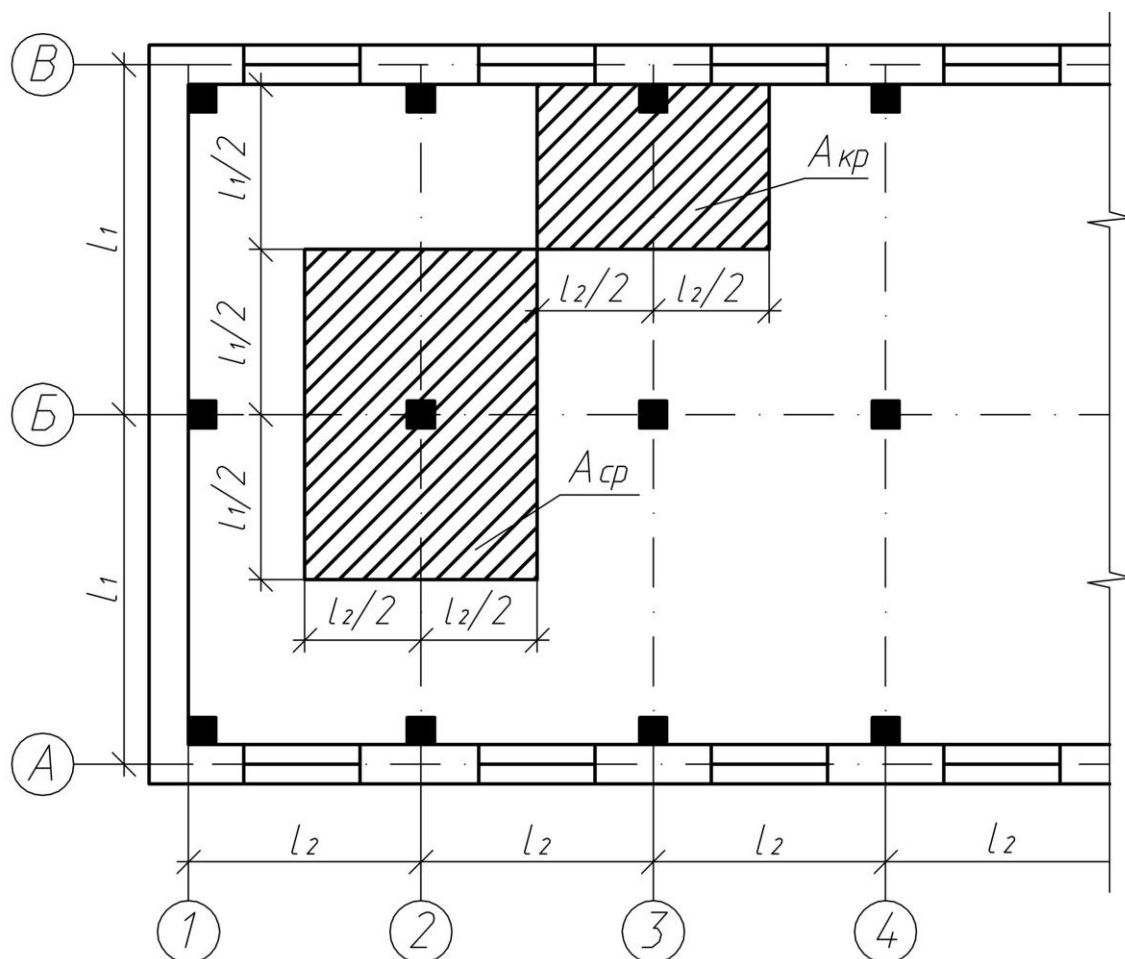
Схематичный план здания и определение грузовых площадей
